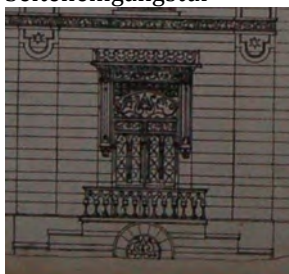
Planmaterial Ansicht Ausschnitt Seiteneingangstür
